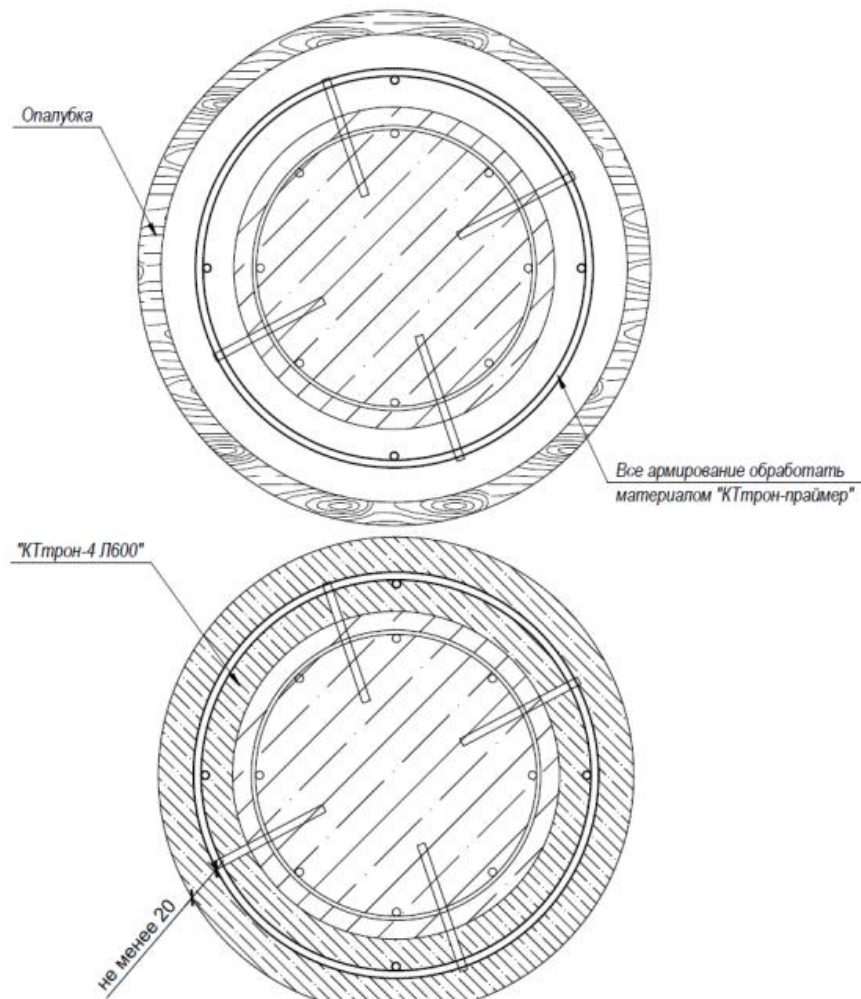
Схема усиления ж/б фундаментов опор моста с установкой обоймы
